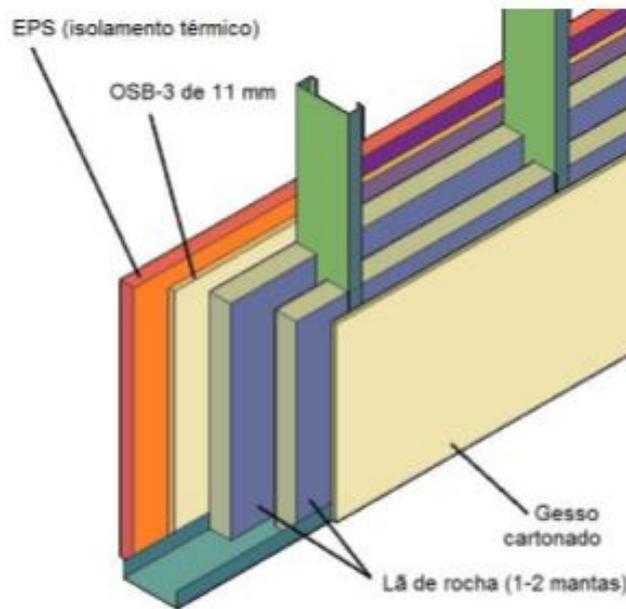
Estrutura típica de parede exterior (Silvestre et al, 2013)
